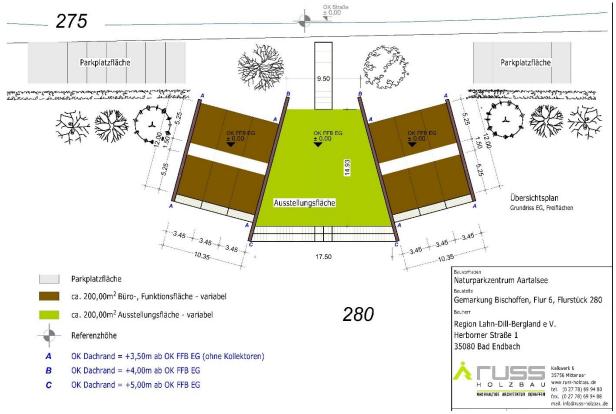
Lageplan des Naturparkzentrums mit Darstellung der Ausstellungsfläche sowie den angrenzend geplanten Büro- und Funktionsflächen
